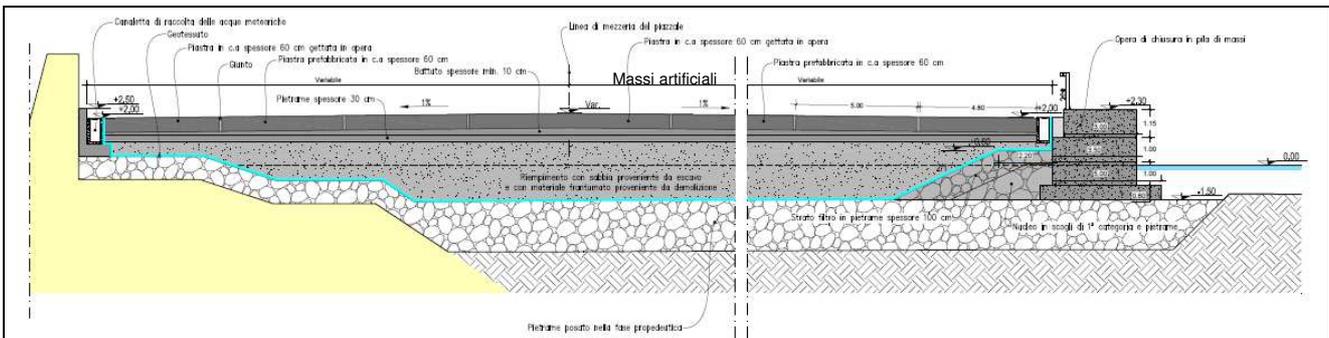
Progetto Definitivo: Sezione tipo dalla prog. 71,00 m alla prog. 260,00 m
